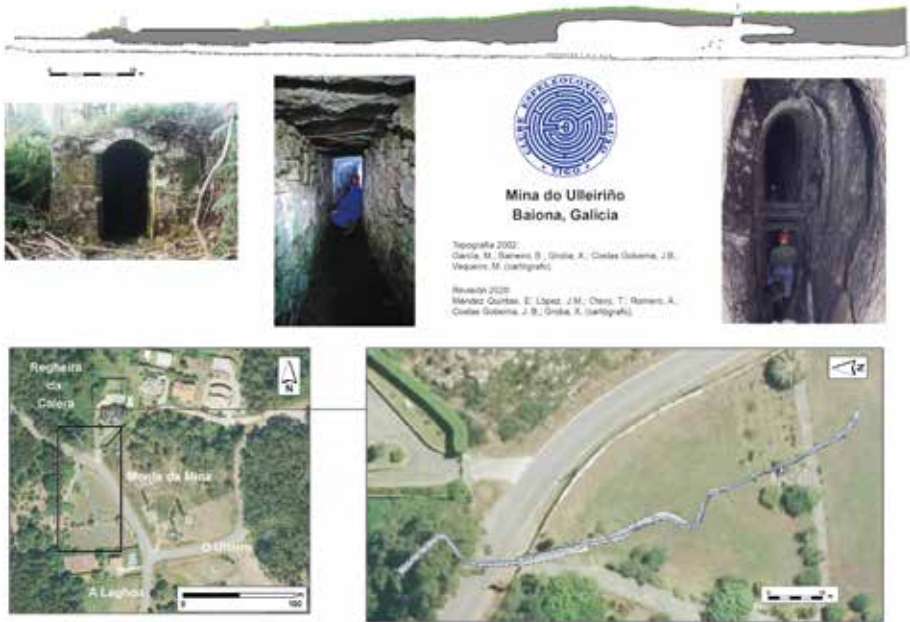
Alzado topográfico da Mina do Ulleiriño e planta sobre a fotografía aérea da zona (Fonte: CEM) e hidrotopónimos próximos (Fonte: Anxo Rodríguez Lemos).
